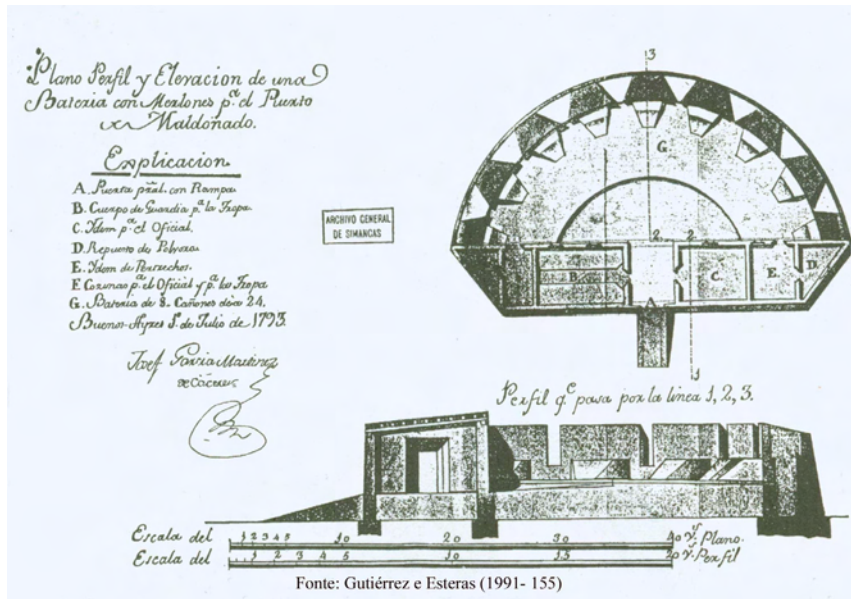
Planta: Bateria com merlões para o porto de Maldonado (1793)
